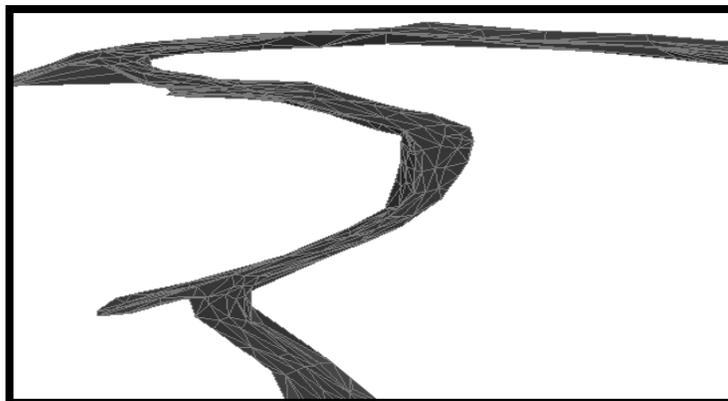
Modelado AutoCAD Civil 3D del terreno.
